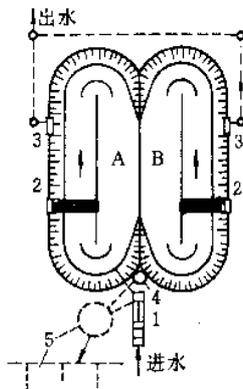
Grundriss einer Zweigräben-Art
